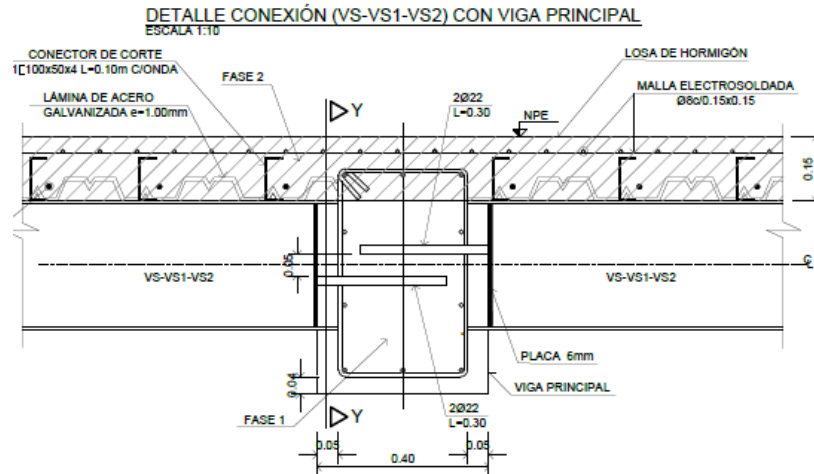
Detalle de conexión de vigas metálicas a viga de hormigón y a losa
